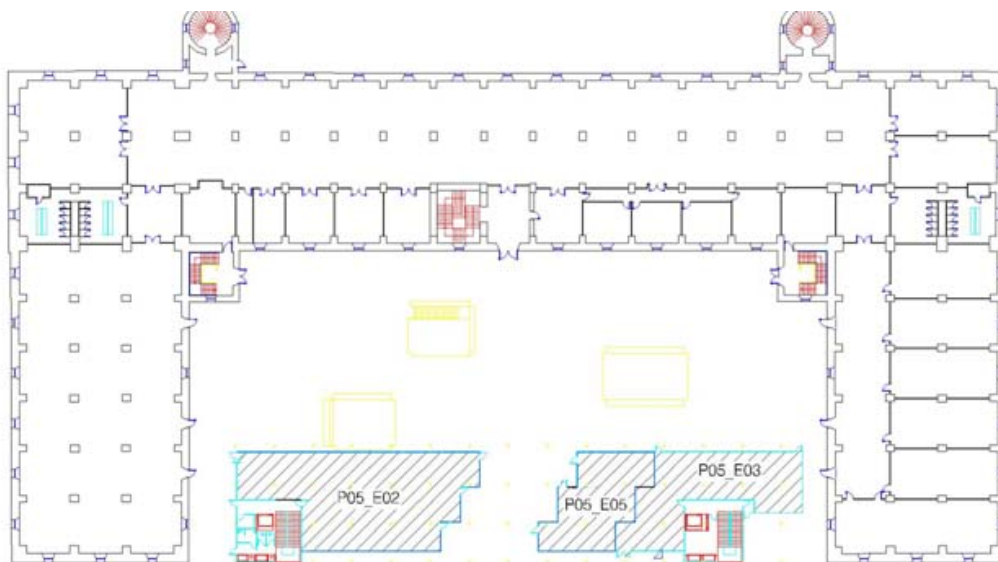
Agrupación de zonas planta baja edificio nuevo.
